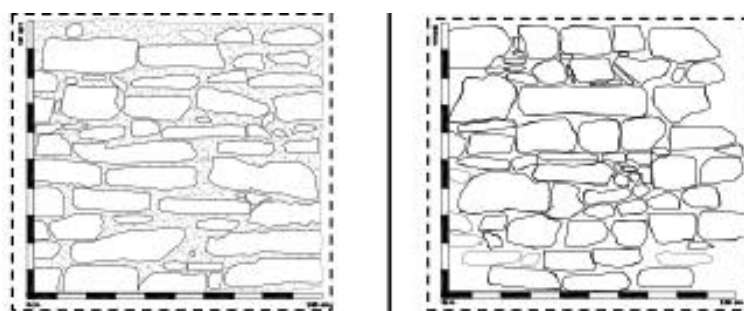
Murature in pietra a spacco con buona tessitura
